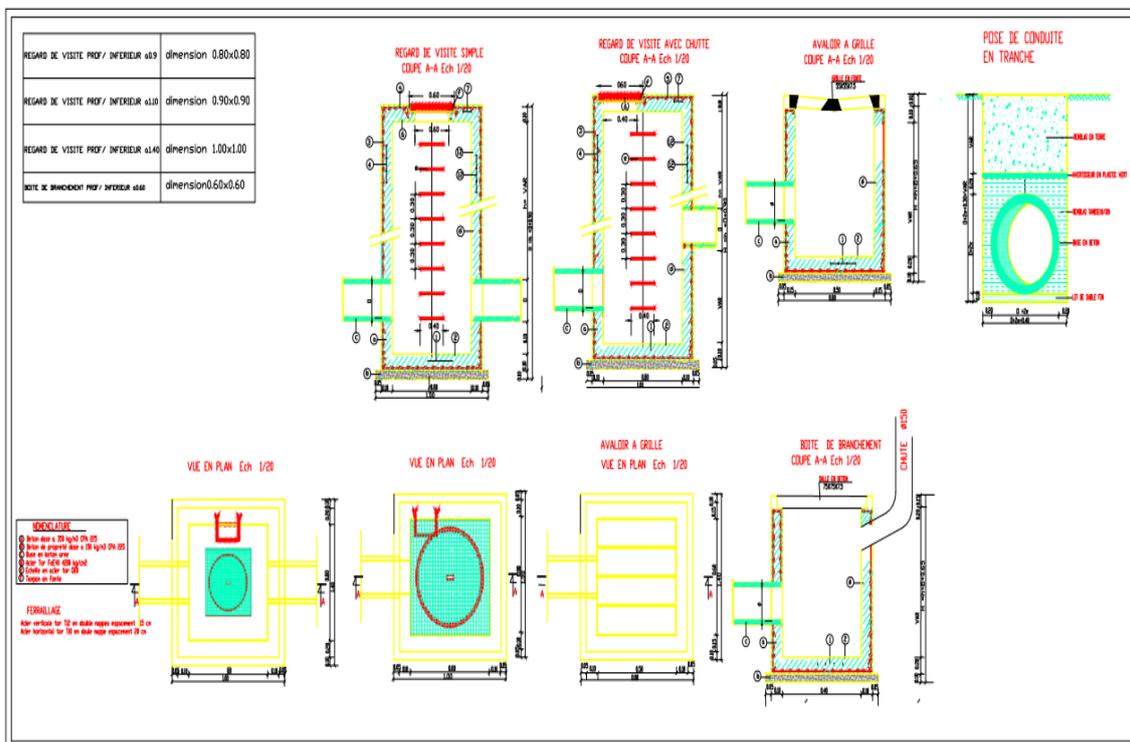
Regards (de branchement, de visite) et boîtes de branchement , exemples de détails techniques constructifs . source : BET privé
